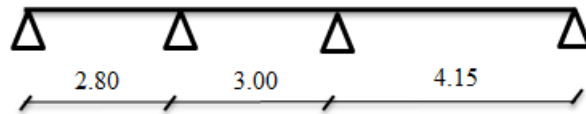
Poutrelle type 06 Plancher RDC (terrasse accessible)
